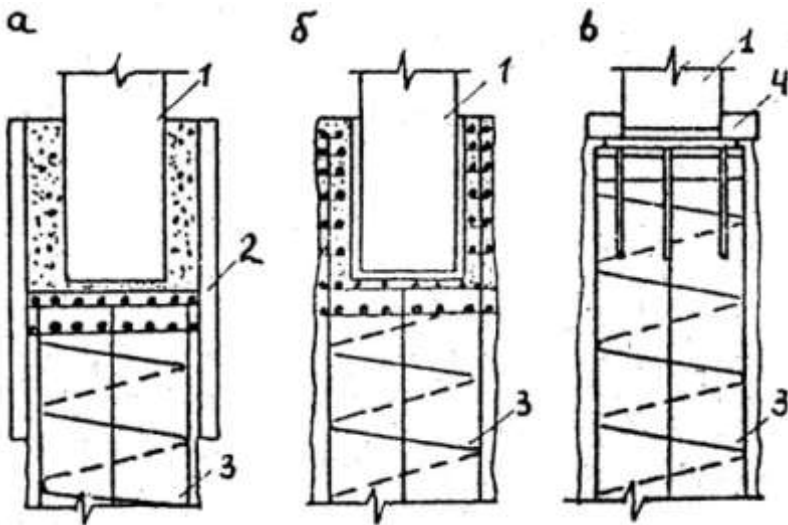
Сопряжение буронабивной сваи с колонной: а - с помощью кольцевой посадки; б - устройством стакана в свае; в - сварным стыком; 1 - колонна; 2 - насадка; 3 - свая; 4 - сварной стык.
